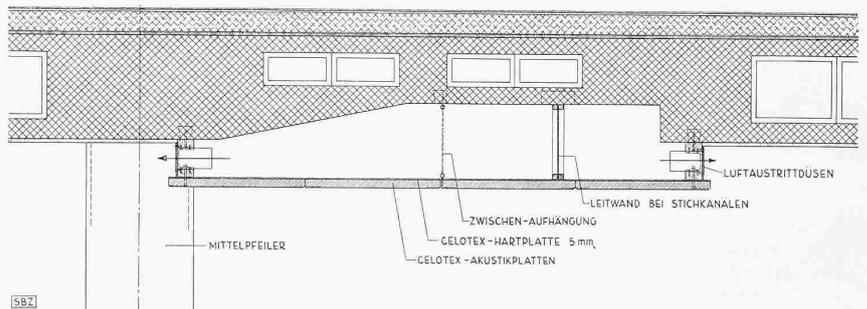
Deckenschnitt mit angehängtem Zuluftkanal. — Masstab 1 : 20
